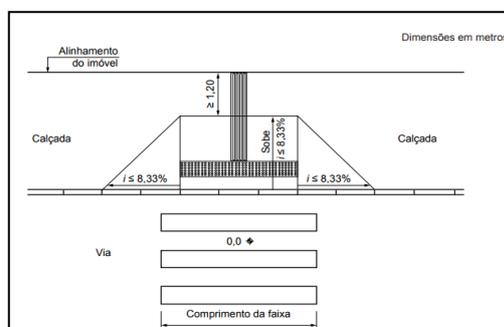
Rampas de acesso. Fonte: NBR 9050.
